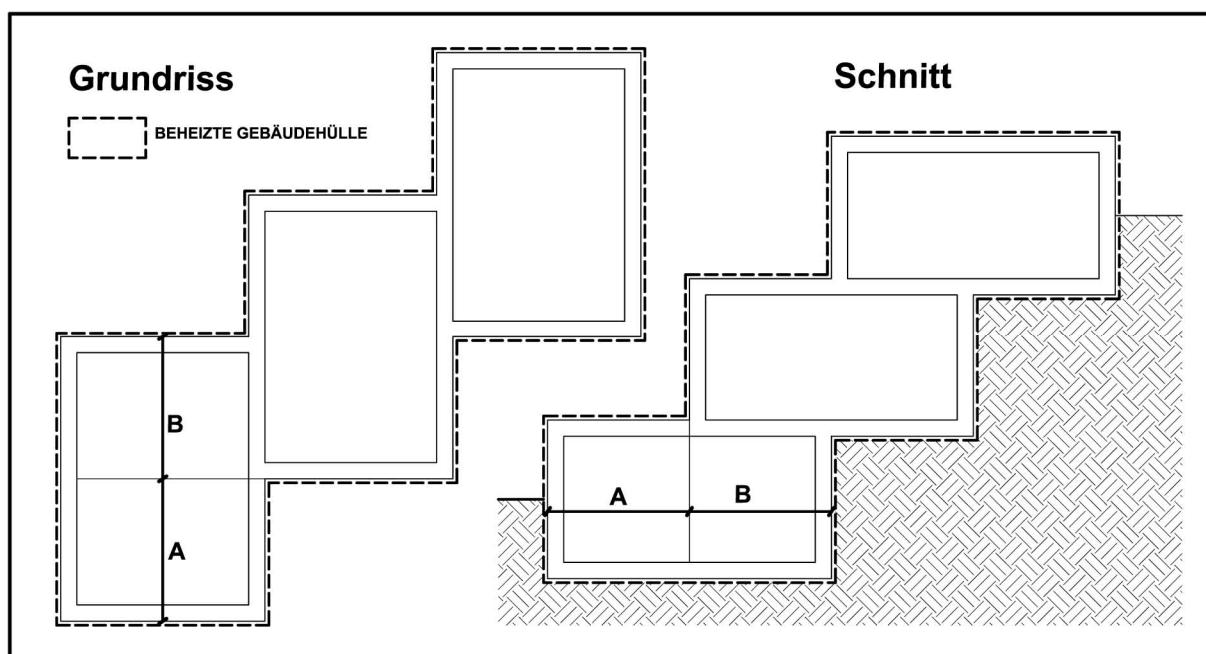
Grundriss und Schnittansicht einer Reihenhausanlage (Fall 2)
